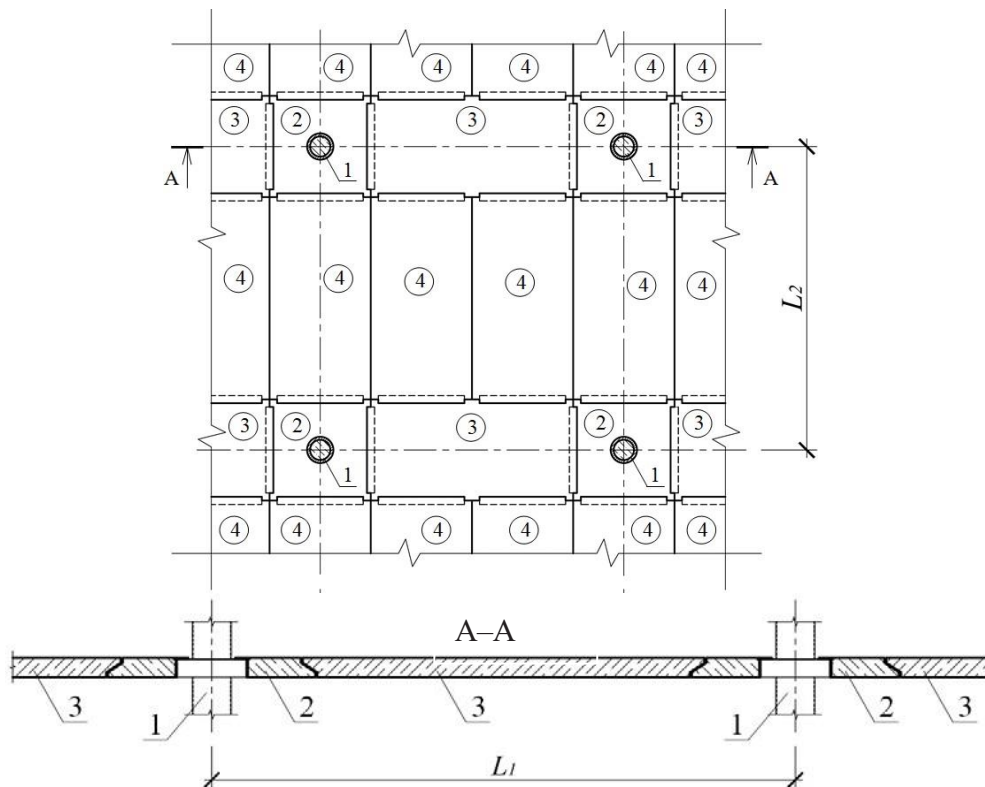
Схема збірного залізобетонного безбалкового перекриття
